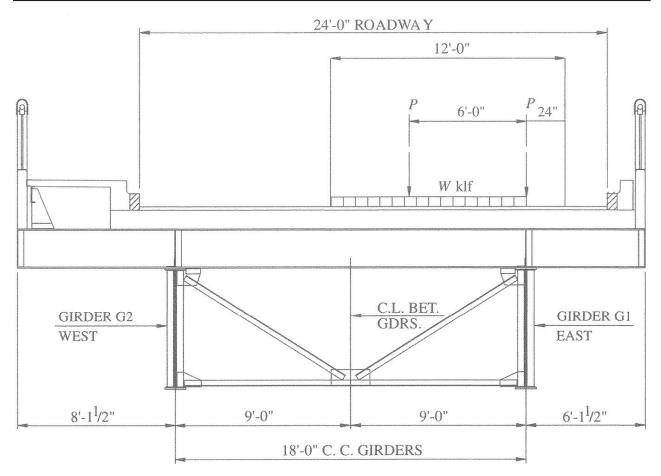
Posición crítica para producir el corte máximo en la viga del piso
